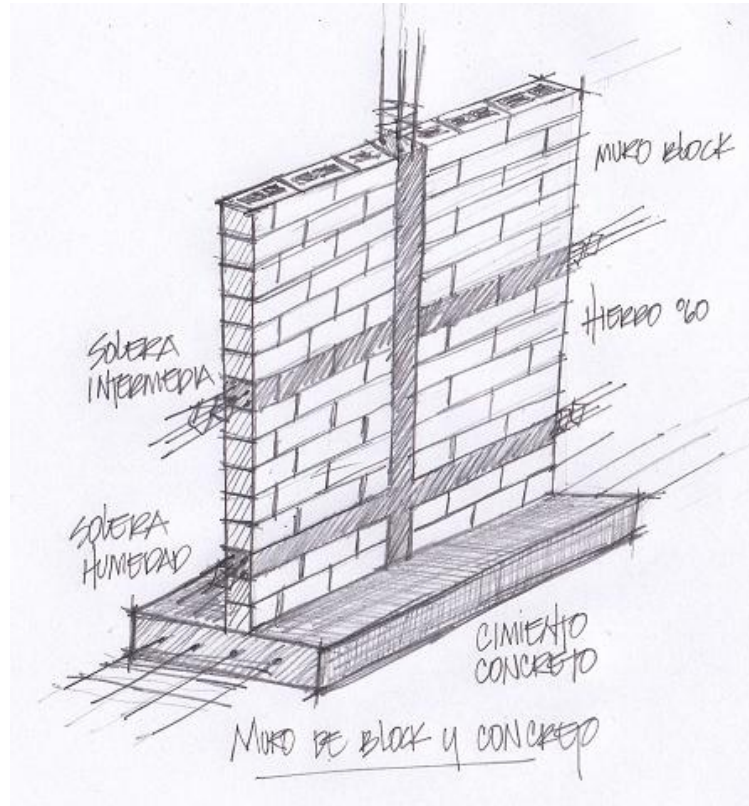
MURO DE BLOCK Y CONCRETO
